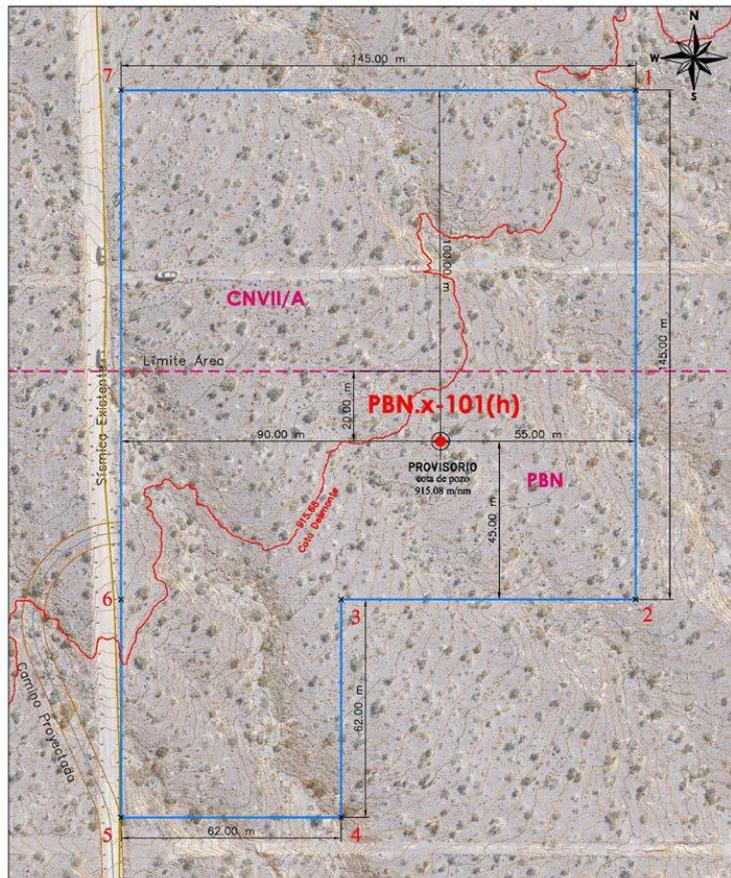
Croquis de la locación proyectada y tramo del camino de acceso a acondicionar
